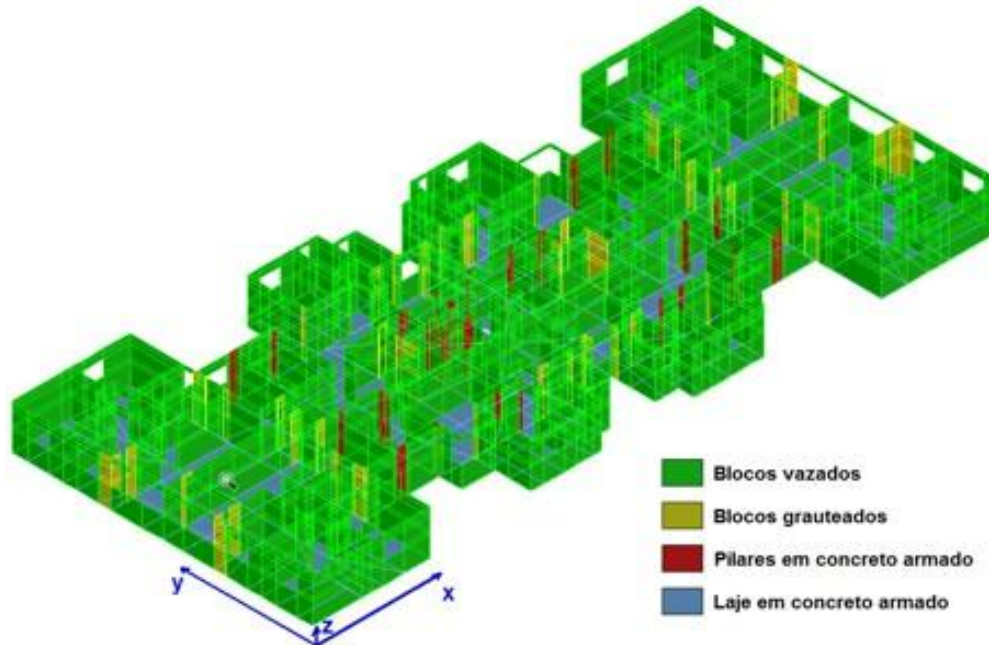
Elementos estruturais distribuídos num pavimento tipo residencial
